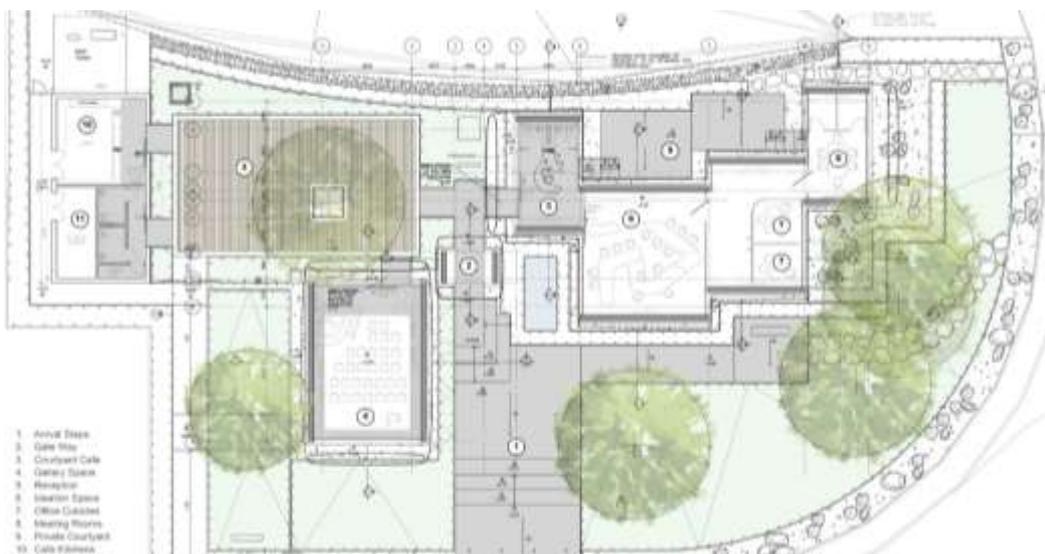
Plan rez-de-chaussée source : (Gensler, 2016)
